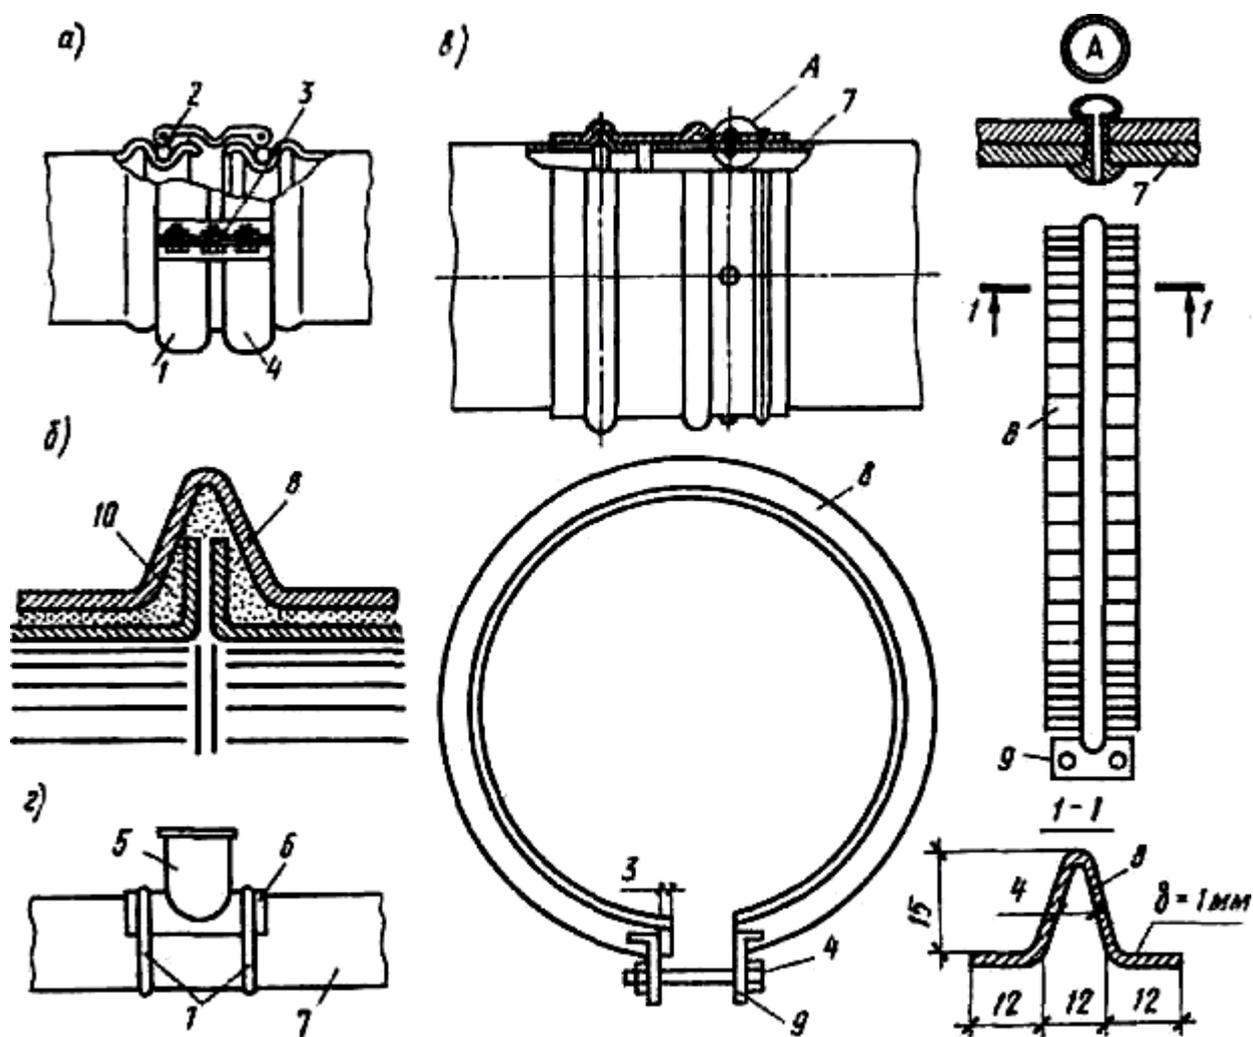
Бандажное соединение звеньев воздуховодов:
